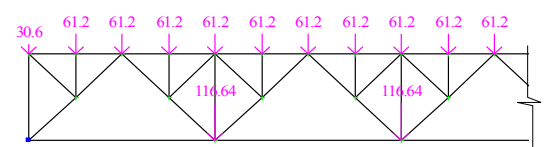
Схема загрузки 3 (сейсмическая нагрузка)
